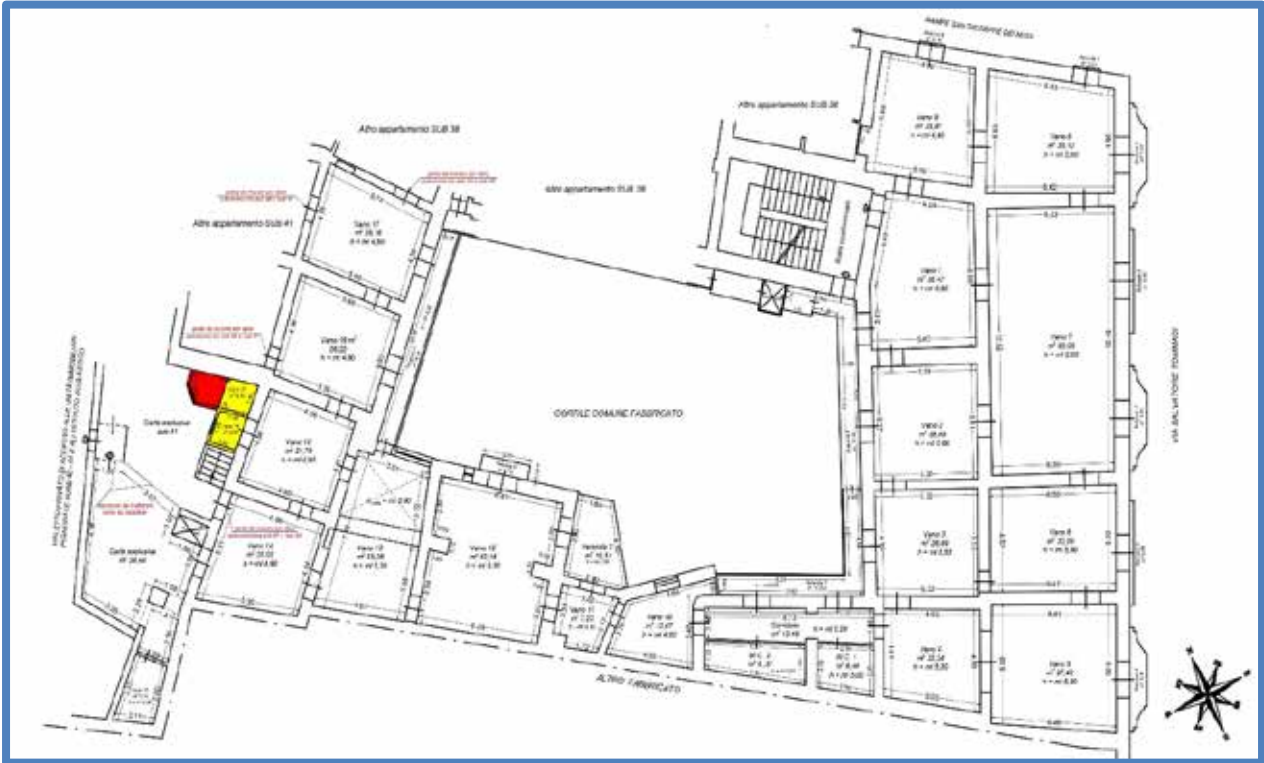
Planimetria del rilievo dello stato dei luoghi appartamento sub 40.
